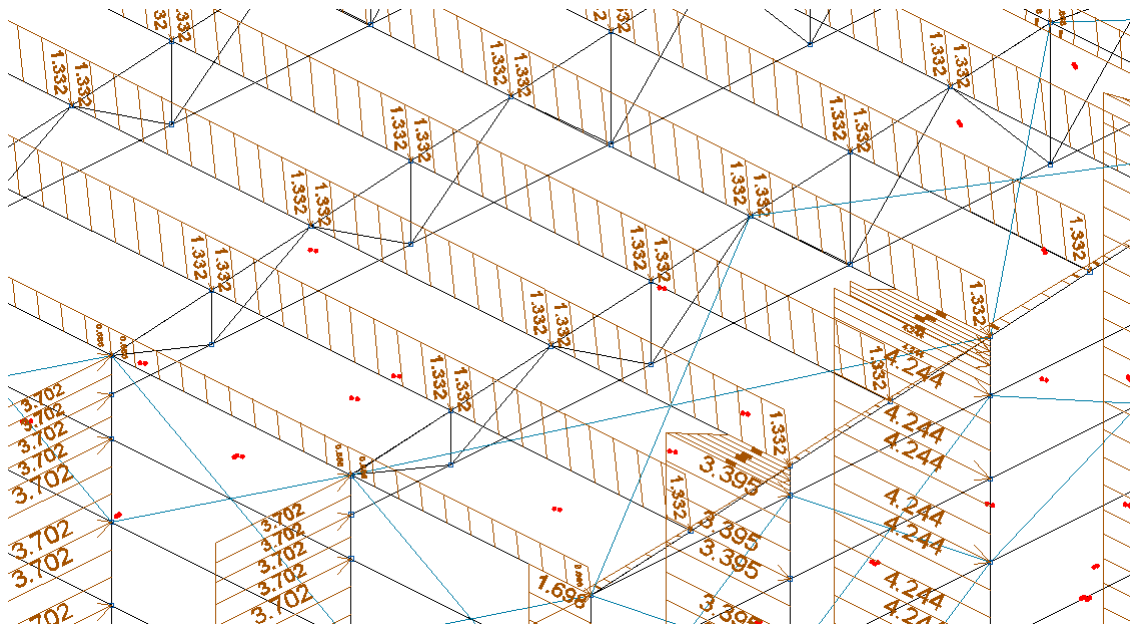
Fachada frontal de la nave, zona ABC, cargas de viento
